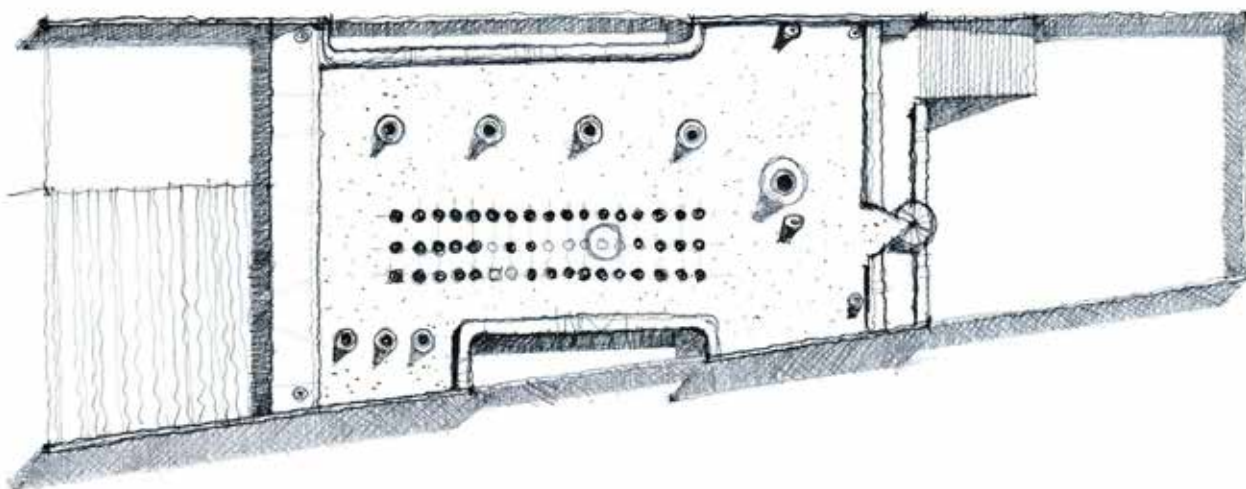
Casa Jacks Zitronenblatt; Forte Netto e irmãos Gandolfi; planta de cobertura.
